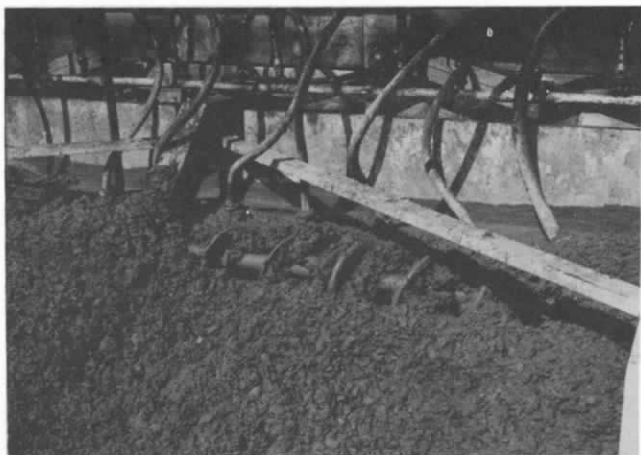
Mise en oeuvre du béton devant de la machine
